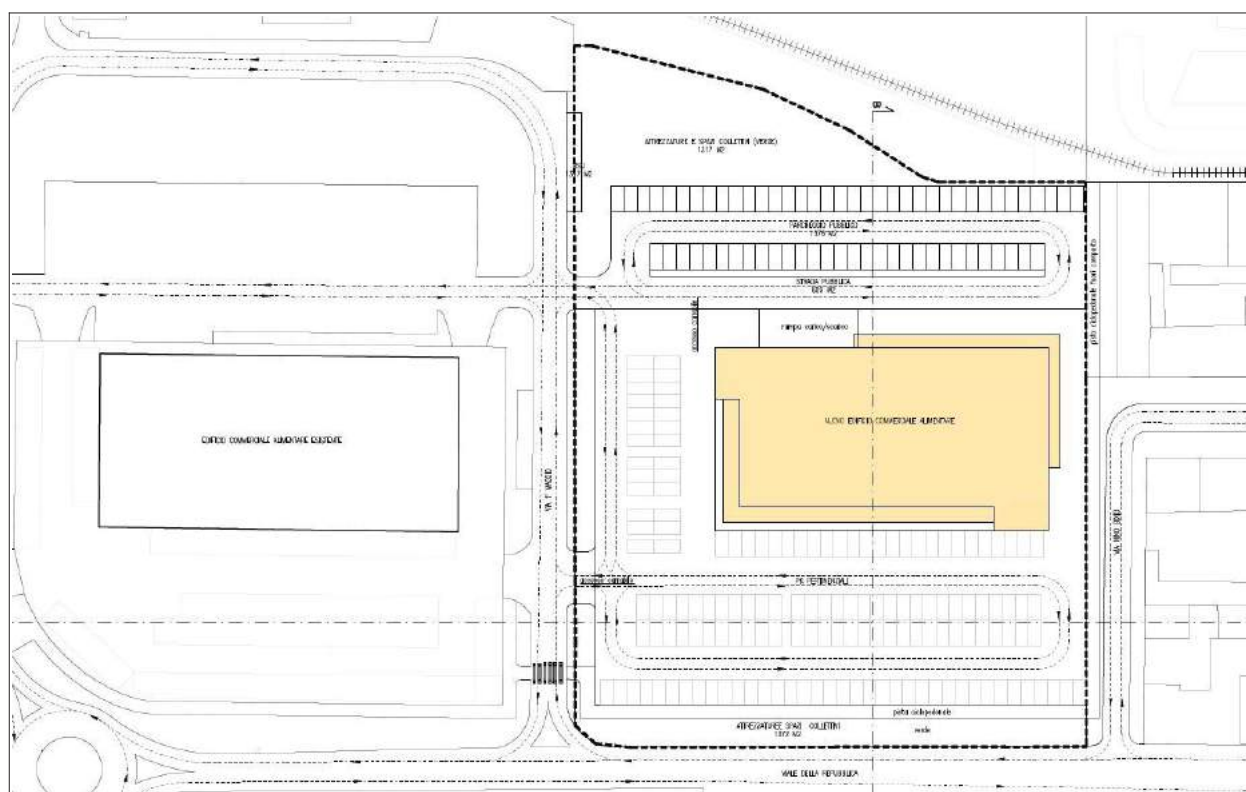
Planimetria del progetto urbanistico comparto “Ex Pempa” di Massa Lombarda
